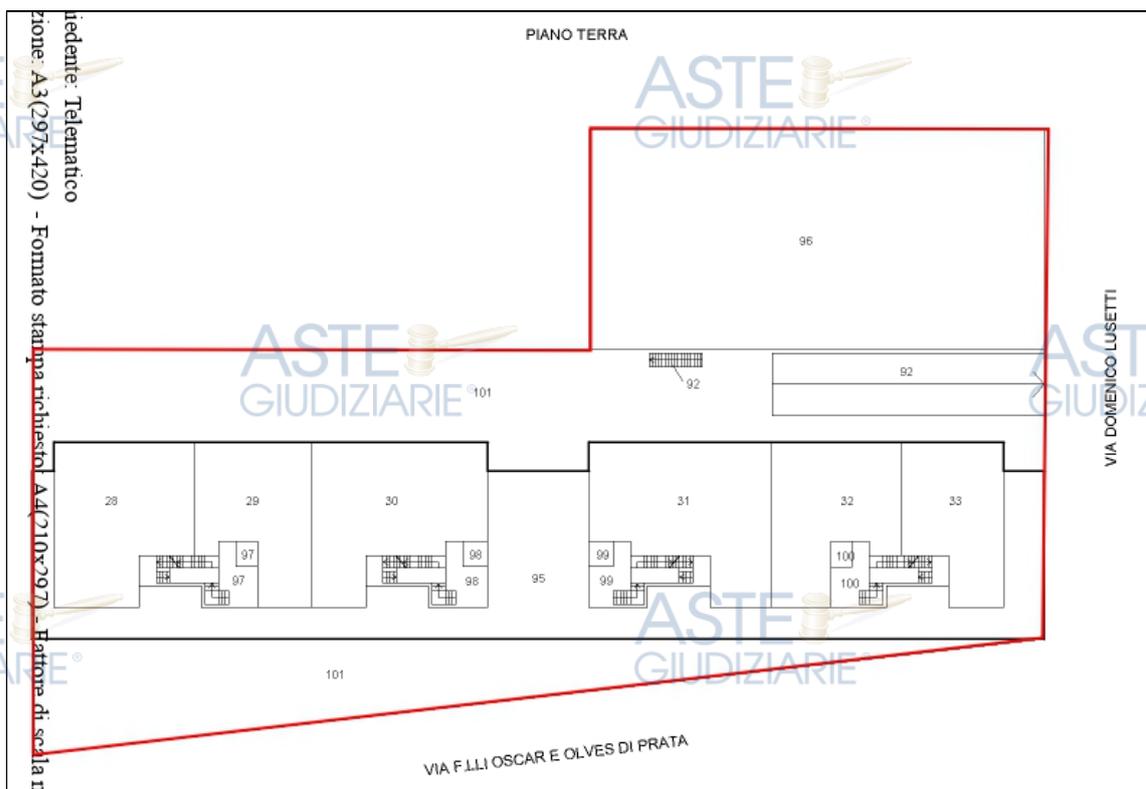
Estratto elaborato planimetrico ultimo in atti con indicazione del perimetro di proprietà condominiale
